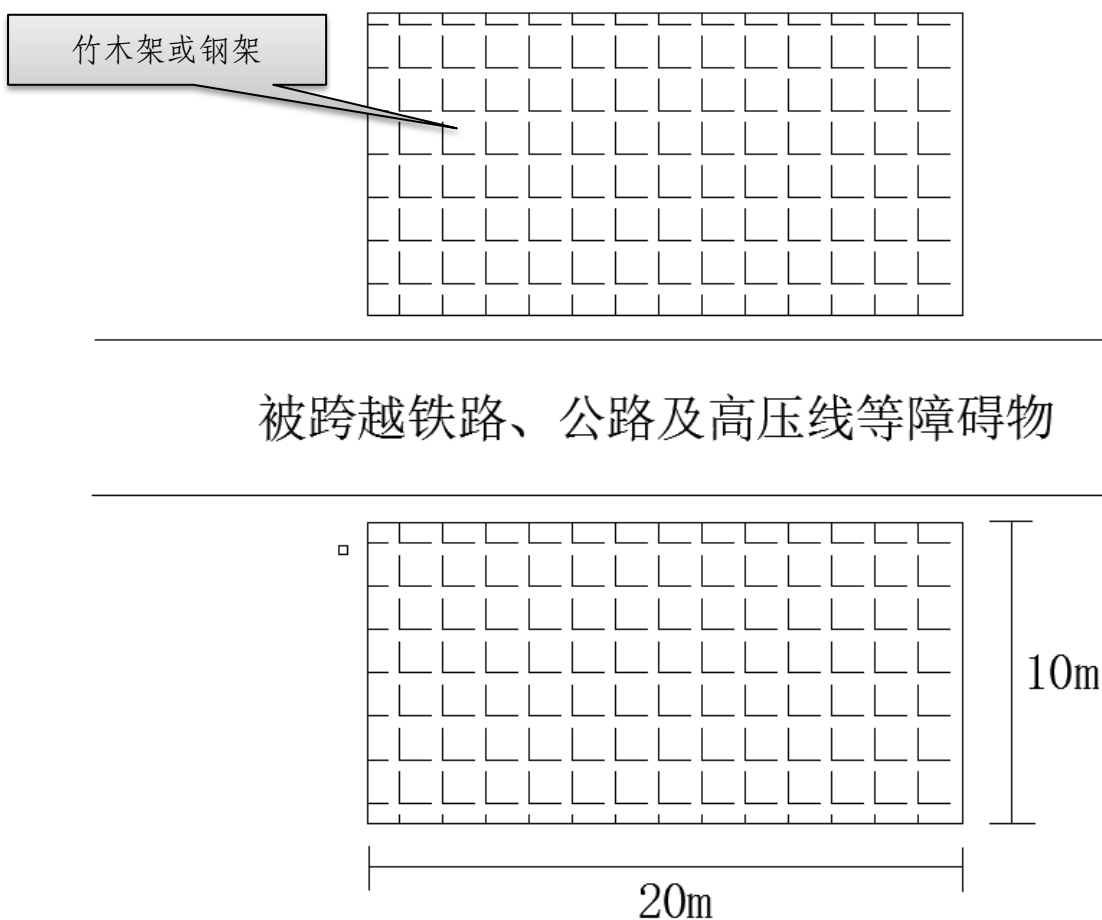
跨越施工场地总平面布置及占地面积示意图
